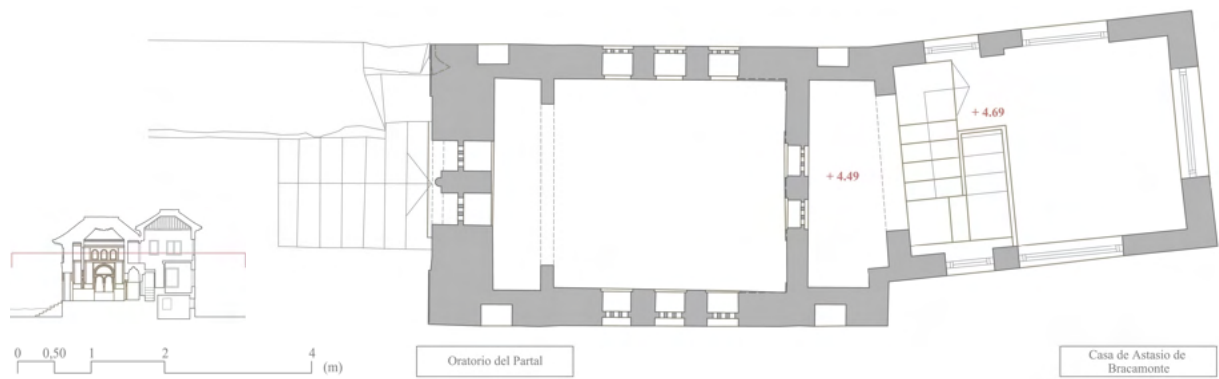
Plano del oratorio. Planta a cota +5,50 m.
